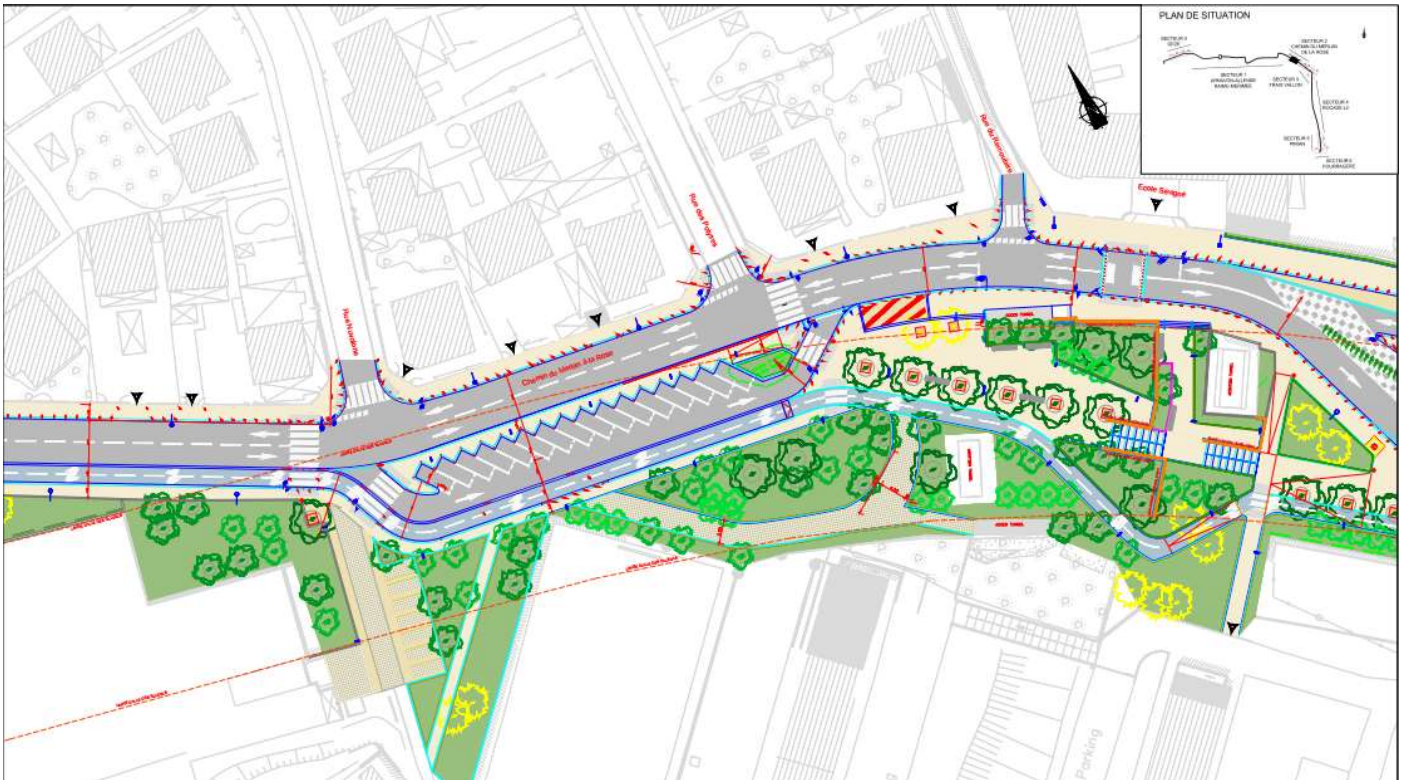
plan de masse des aménagements secteur Sévigné 1/2
